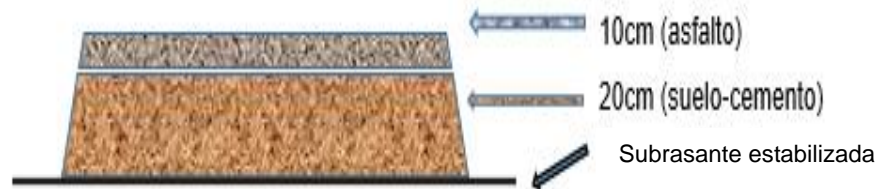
Diseño estructural de pavimento flexible base suelo-cemento
